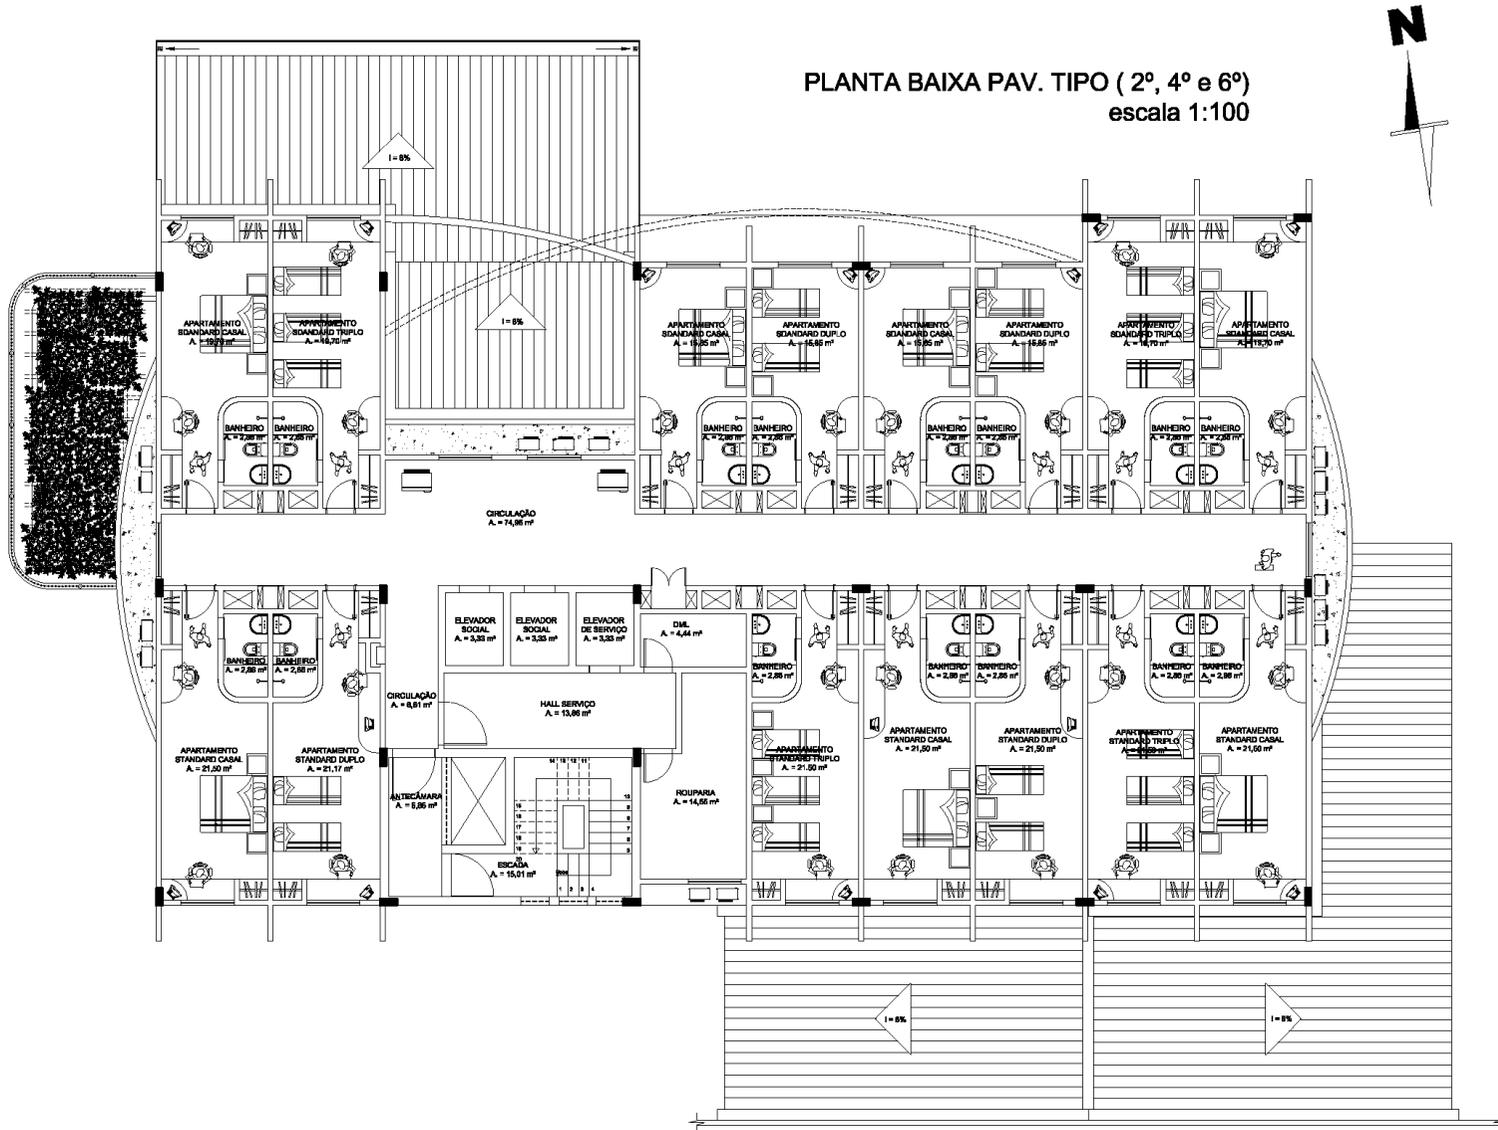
Layout Pavimento tipo andares 2, 4, 6
